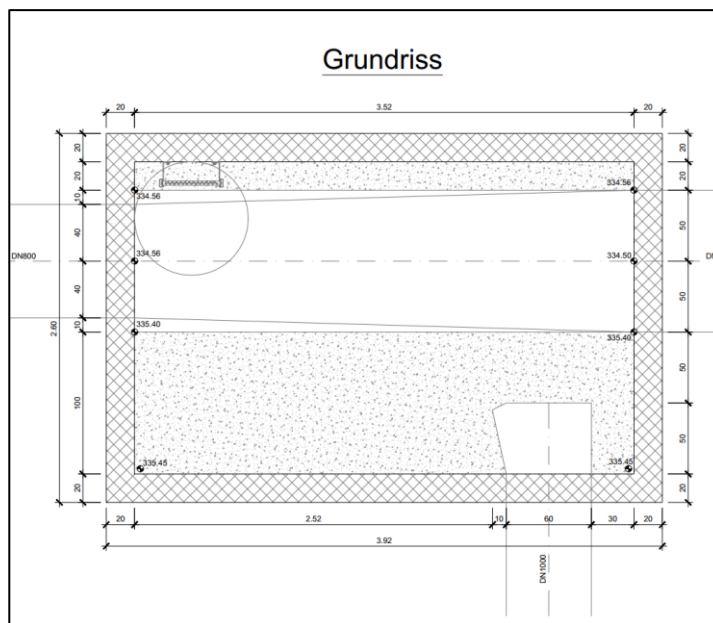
Grundriss RÜ F1030 Brugg
